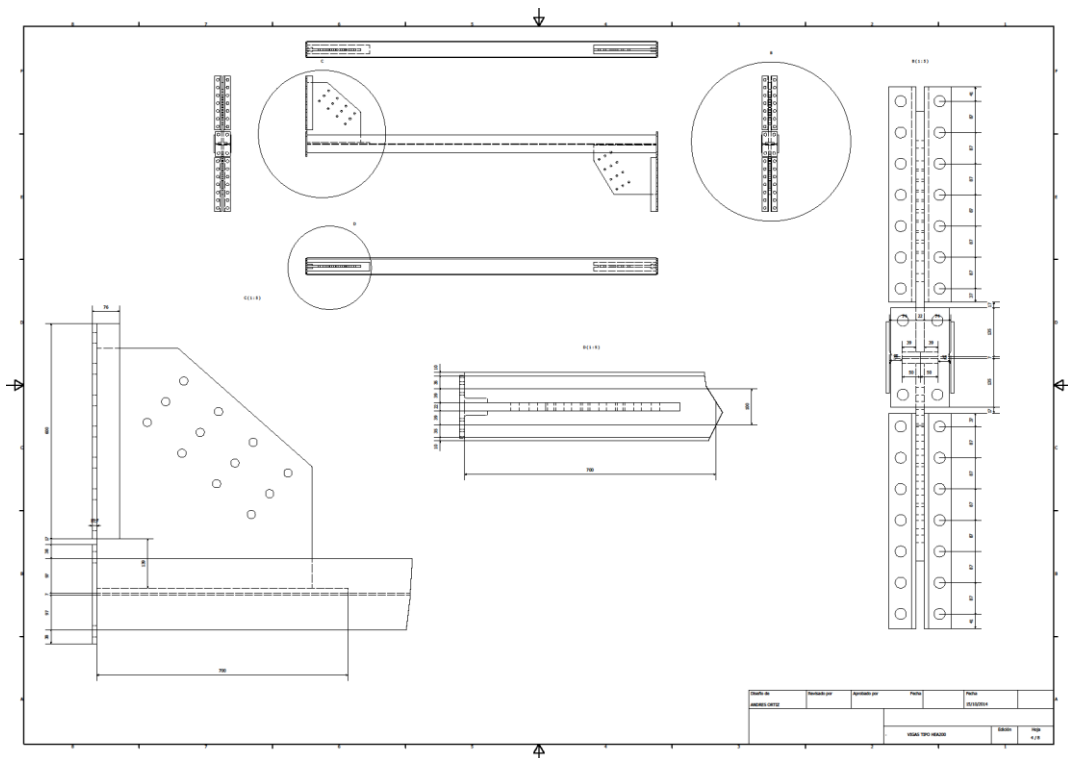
Planos de taller Vigas Tipo para Refuerzo Estructural Col. San Pedro.
